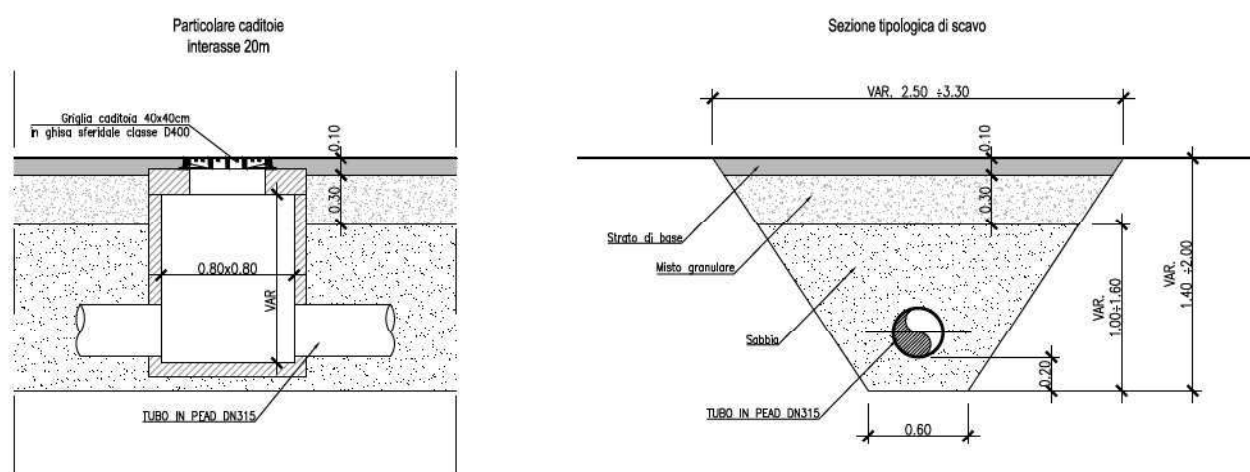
Sezione tipo di scavo della condotta e particolare delle caditoie
